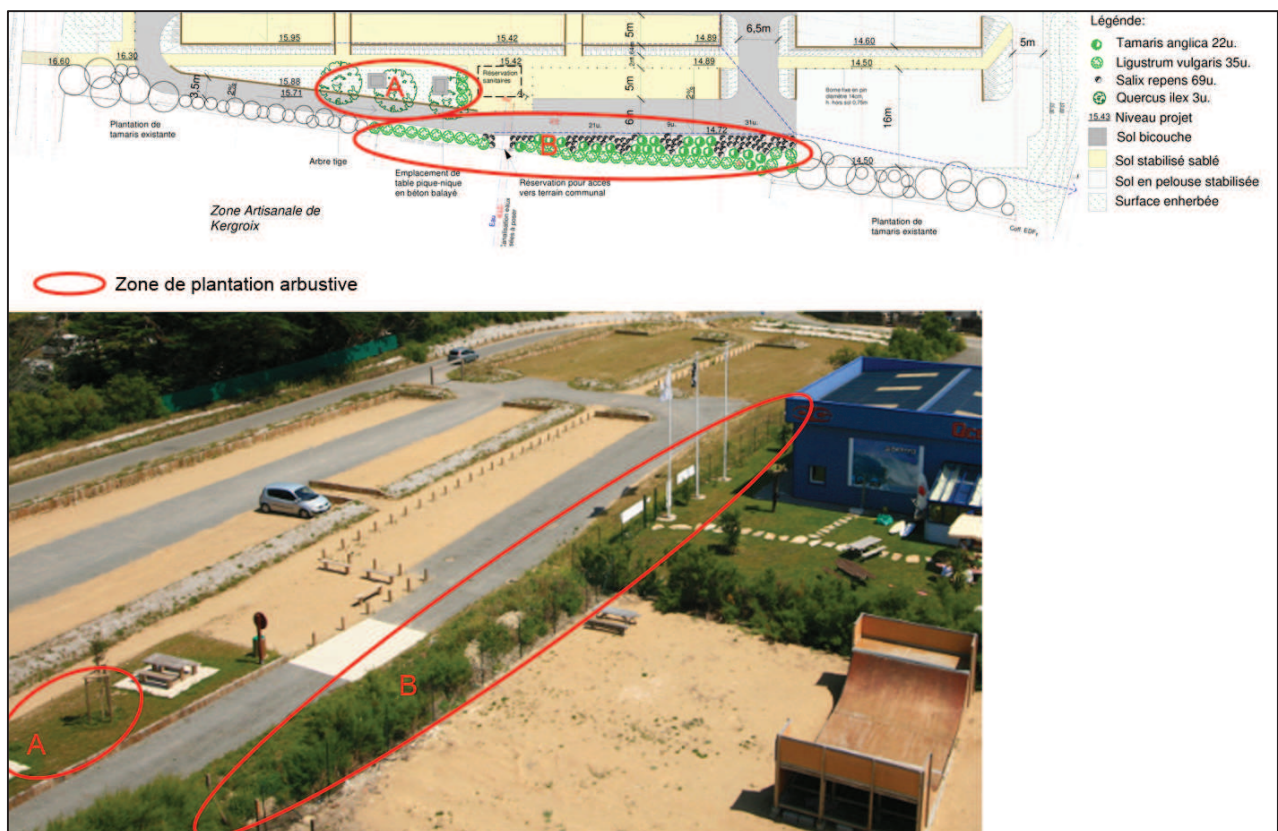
Plan de masse (haut) et photo du parking (bas) de Kergroix (côte sauvage de Quiberon) :
